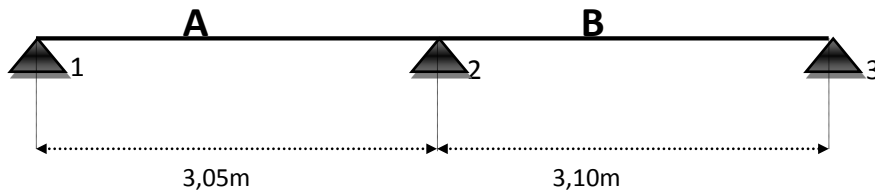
Schéma statique de poutrelle (2^{ème} type).
